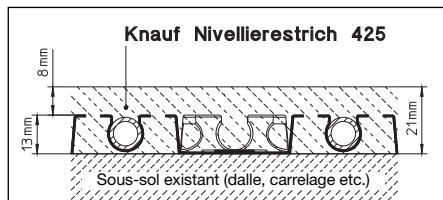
Knauf chape de nivellement 425 (recouvrement minimal 8 mm, hauteur total de mise en œuvre 21 mm)
